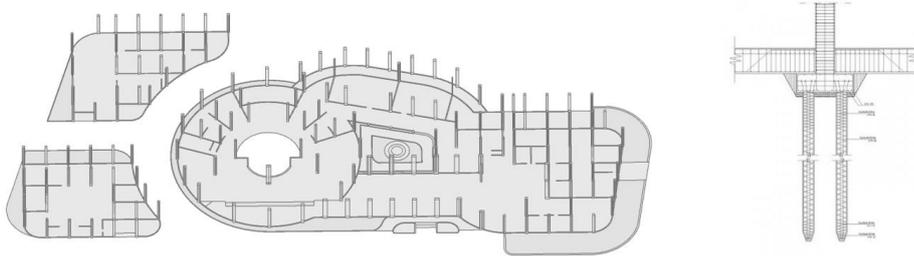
Aplikasi Hubungan Antar Ruang
